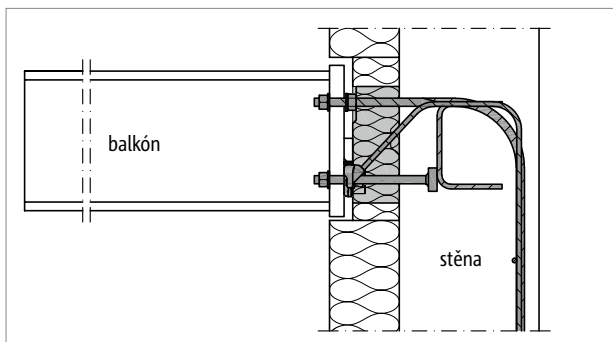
Schöck Isokorb® T typ SKP: Napojení na železobetonovou stropní desku; izolant uvnitř vnějšího zateplení
